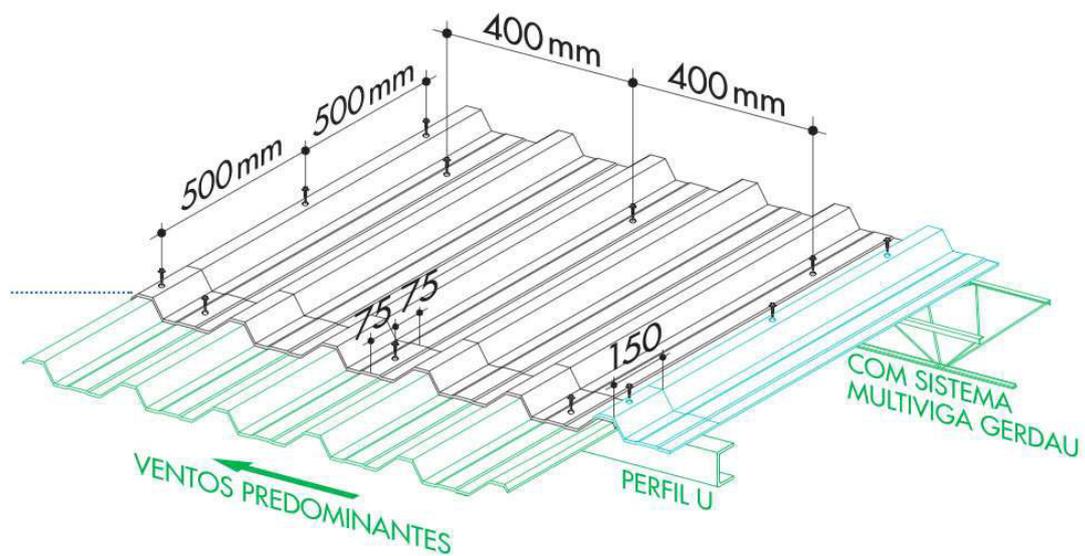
exemplo de instalação. Fonte: catálogo telhas metálicas Gerdau
